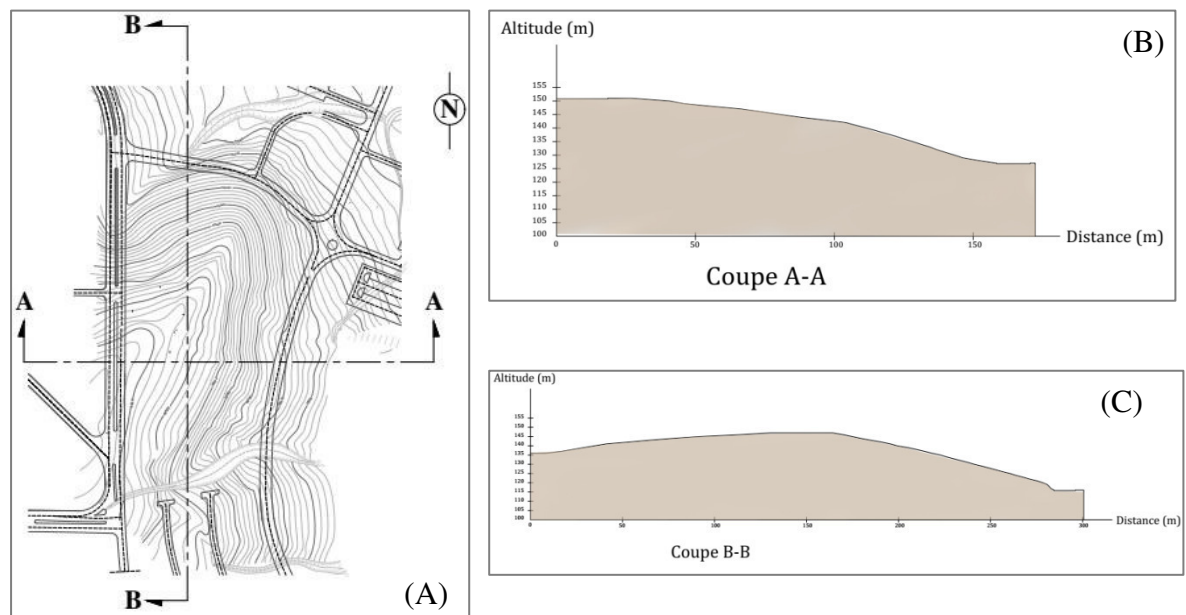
(A) Plan topographique du terrain, (B) Coupe A-A, (C) Coupe B-B.
